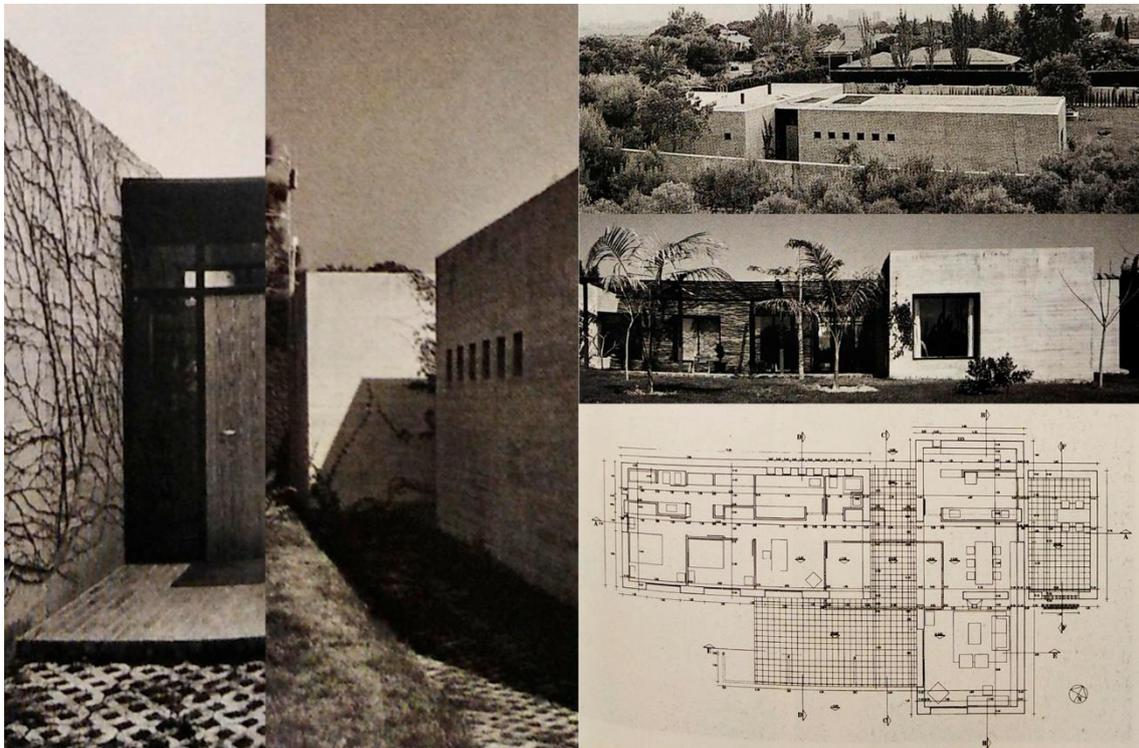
Entrada, fachada norte, vista norte, vista sur y planta.
